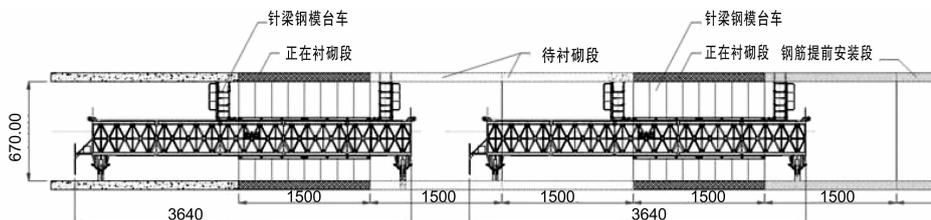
引水隧洞混凝土针梁钢模台车跳仓施工方法图
